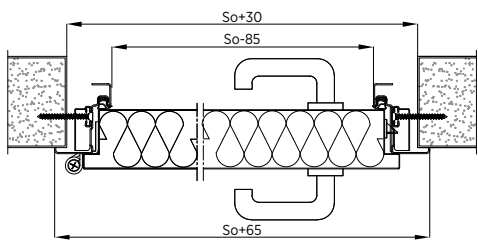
Montage an die Stahlkonstruktion einer einflügeligen Tür mit Eckzarge mit thermischer Trennung - Horizontalschnitt
